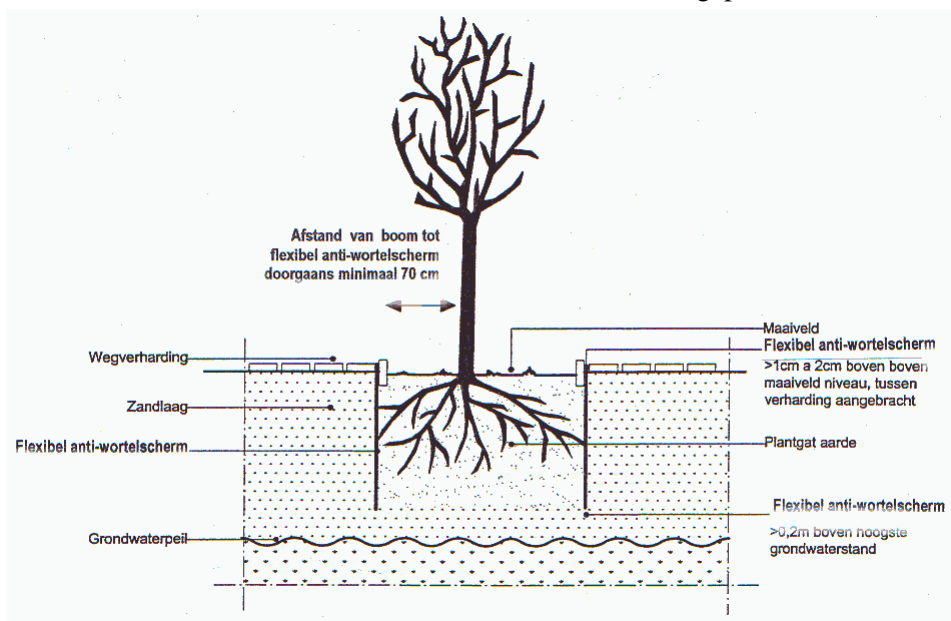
detail 2a – diepte niveau flexibel anti-wortelscherm: barriërevorming door diepe toepassing
